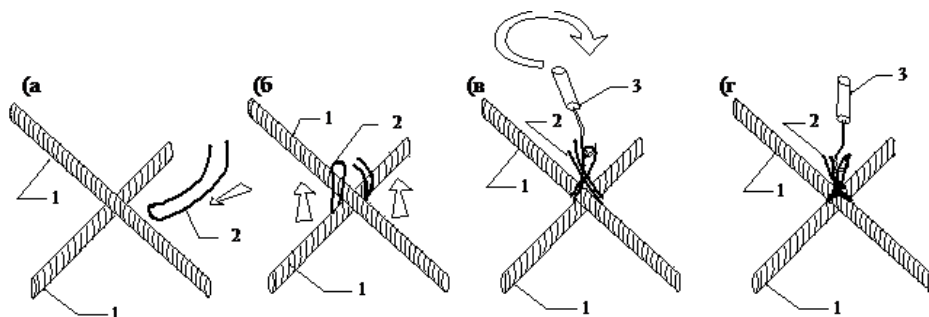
Схема фиксации арматурных стержней вязальной проволокой: а) подергивание проволоки за узлом; б) выравнивание концов проволоки; в) скручивание концов проволоки вязальным крюком; г) зафиксированный узел: 1 – арматурный стержень
